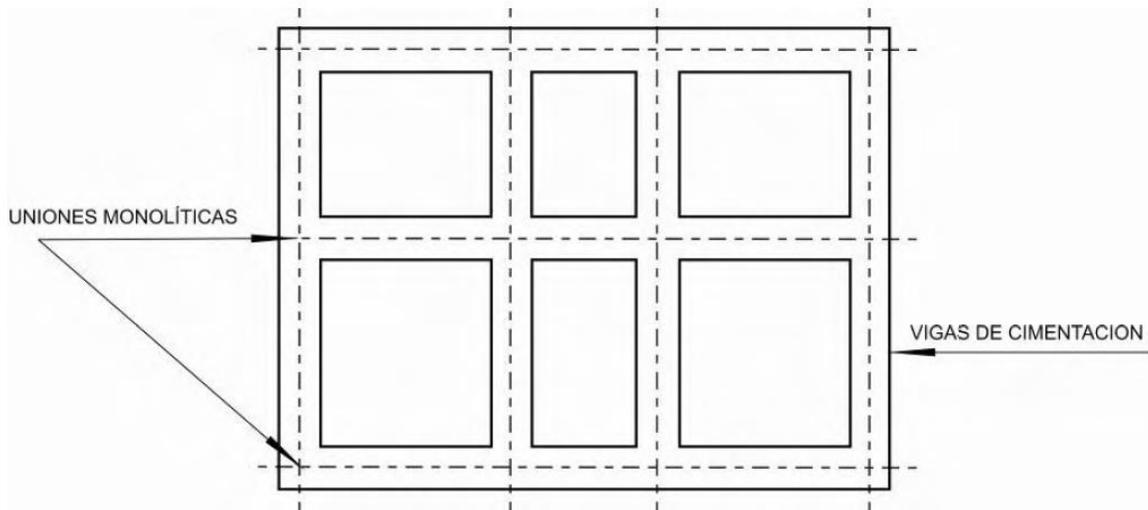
Figura E.2.1-1 Sistema reticular de vigas que configuran anillos cerrados y continuos
